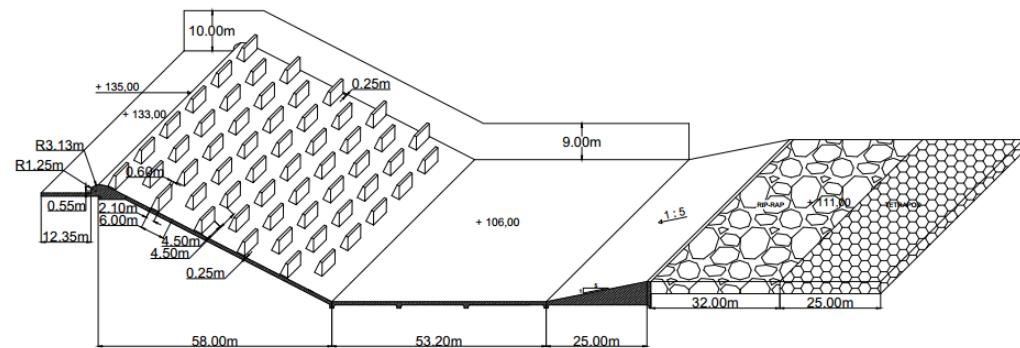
Denah Saluran, Kolam Olak, dan *Escape Channel Original Design
